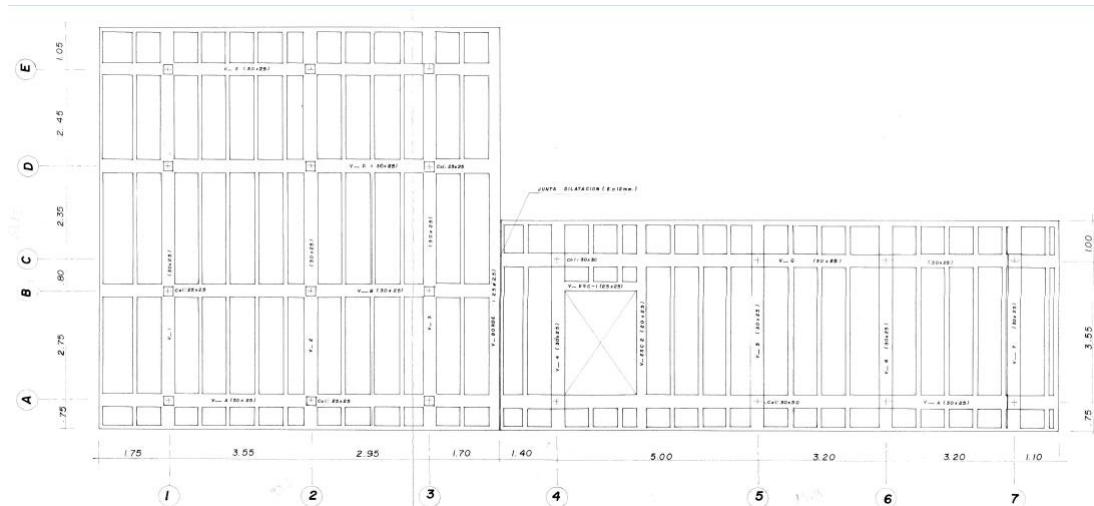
Planta Estructural 2, 3. Edificio Plaza Libertador Artes y Oficios.
